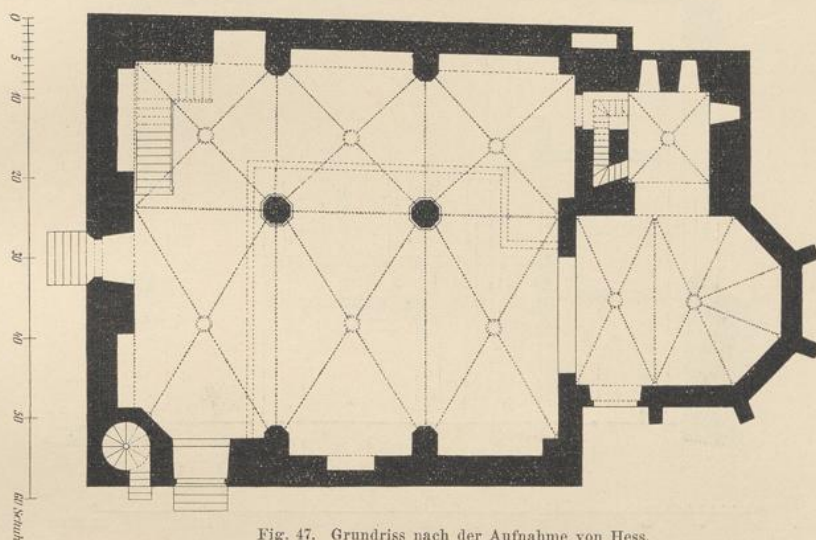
Grundriss nach der Aufnahme von Hess.
